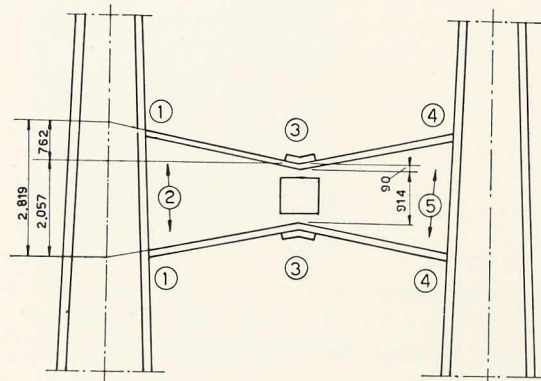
(ci-dessus). Assemblage colonnes-poutres. 1 et 4. Soudures bout-à-bout. - 2 et 5. Soudure de l'âme aux semelles des colonnes. - 3. Plats de liaison.
